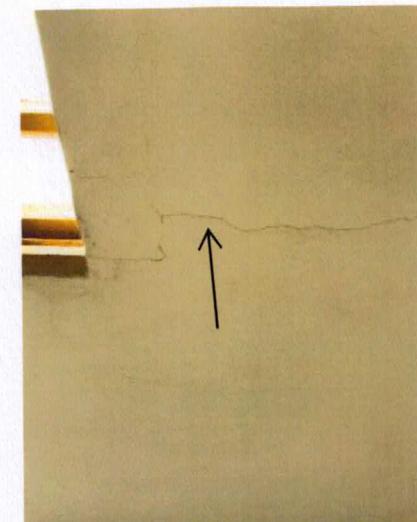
Foto da Parede: Fissuras horizontais abaixo da esquadria - SALA DE AULA
